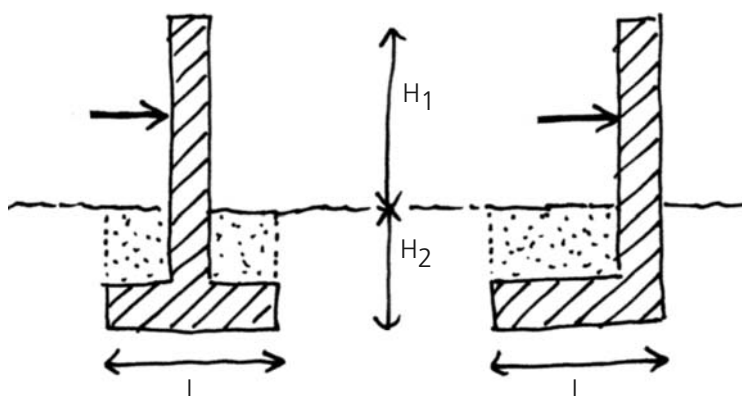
Pré-dimensionnement de la semelle d'un muret isolé
